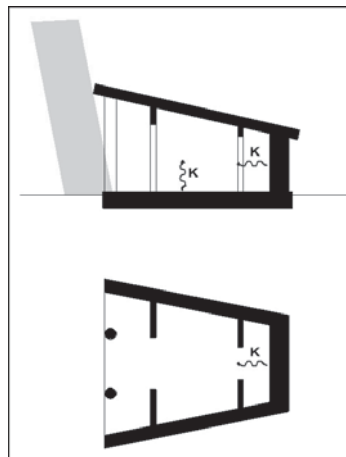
Megaron im Sommer (Längsschnitt und Grundriss)
